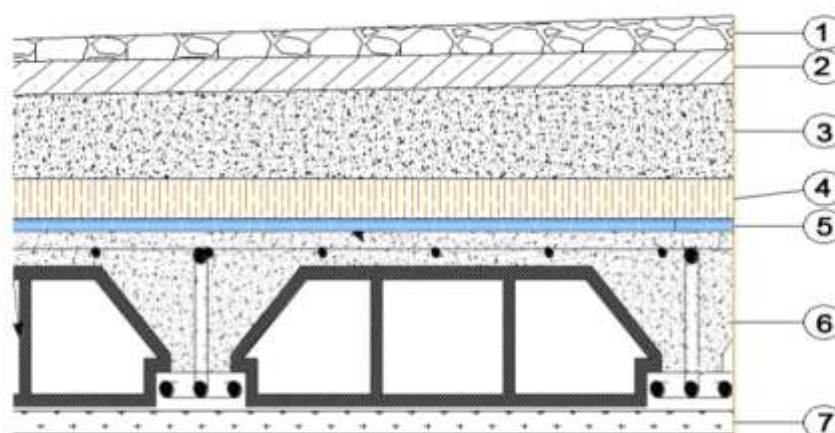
Coupe du plancher terrasse inaccessible en corps creux
